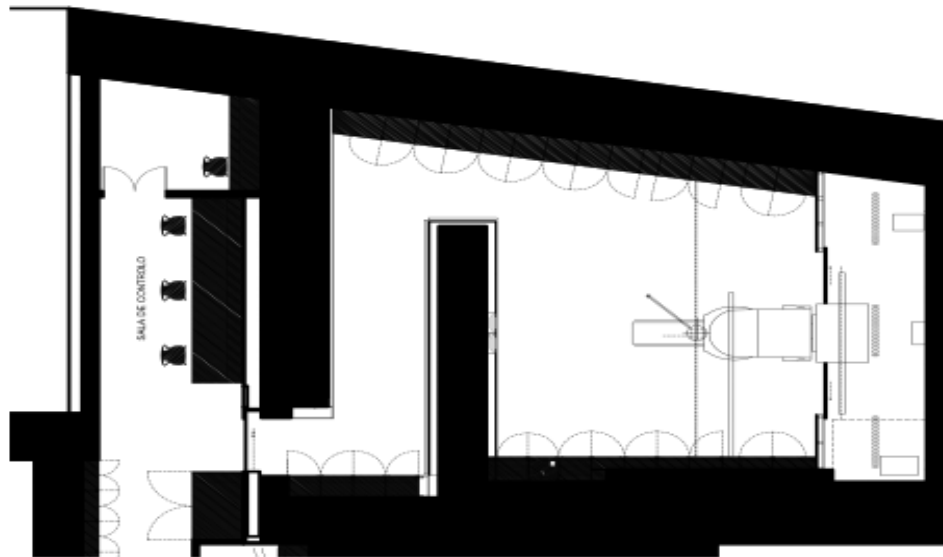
Planta de uma das salas de tratamento do IPOCFG
